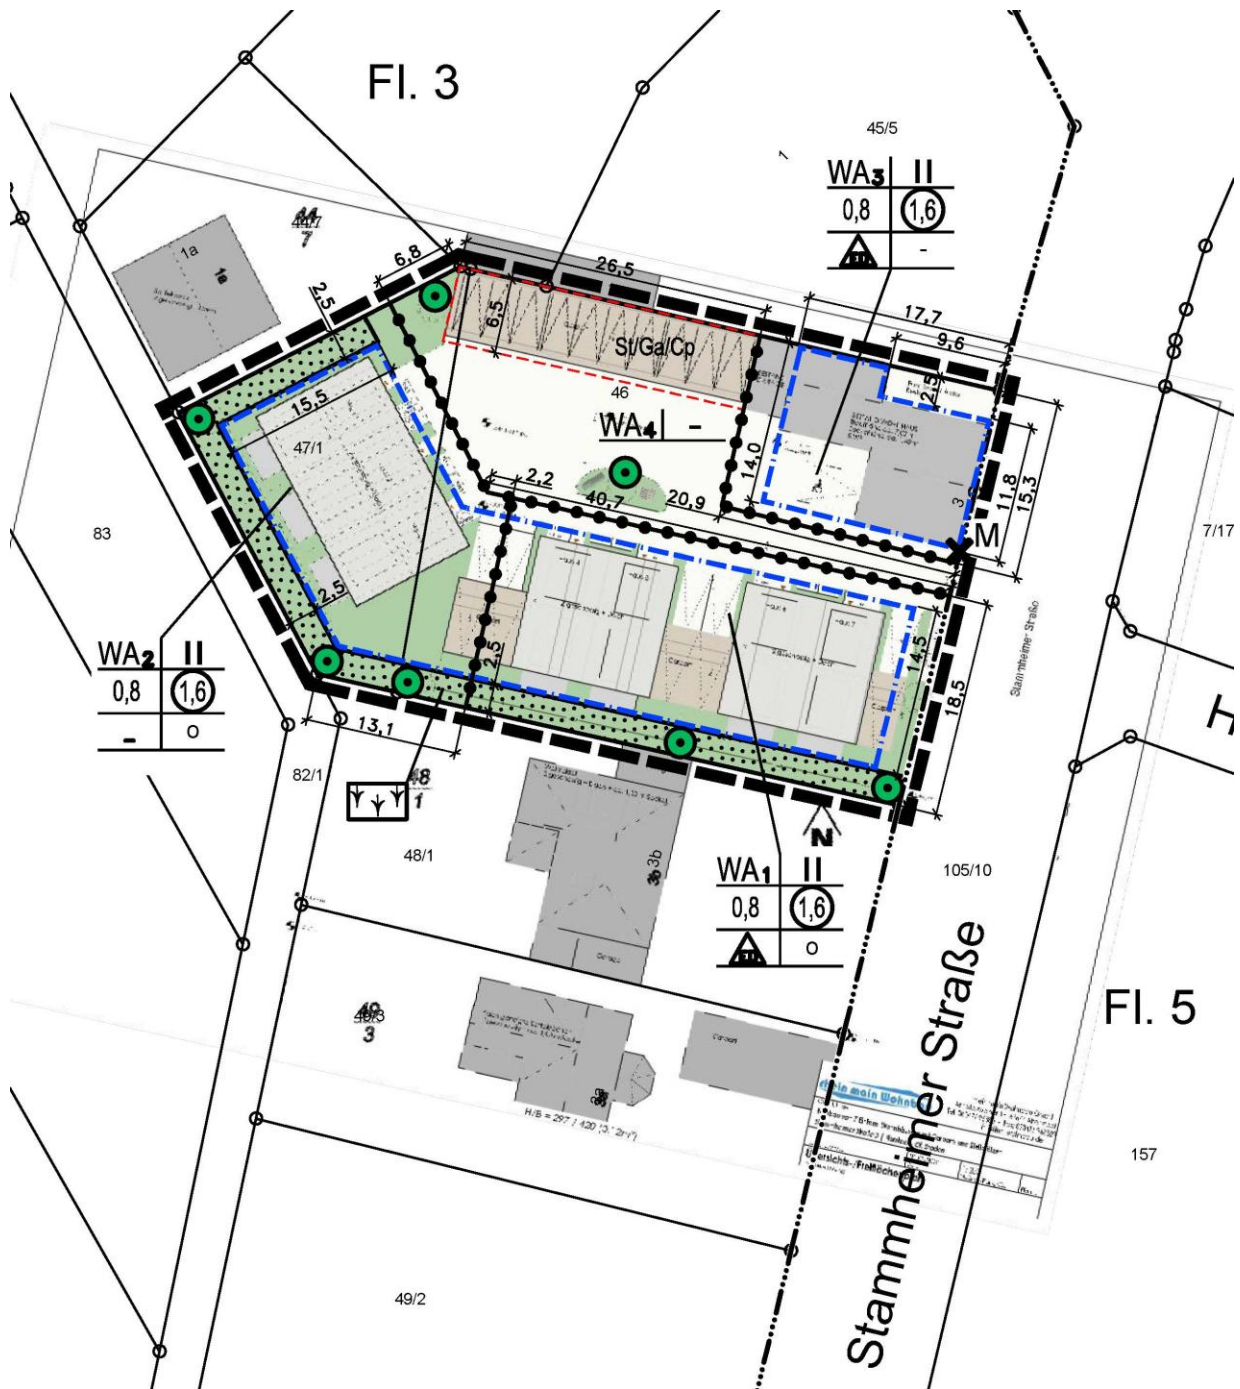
Städtebauliches Konzept mit überlagertem Bebauungsplan
